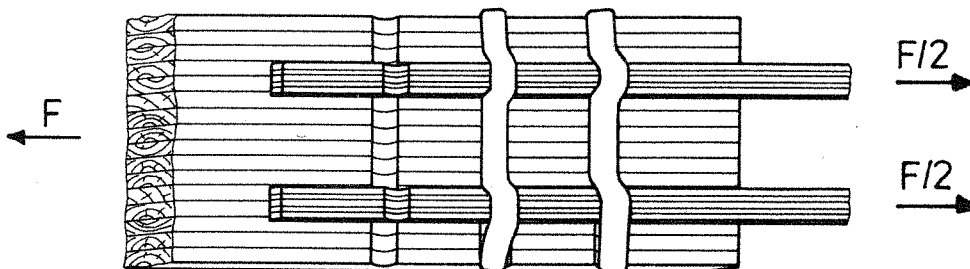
Stabdübelverbindung mit Holzdübeln nach dem Zugversuch /6/
